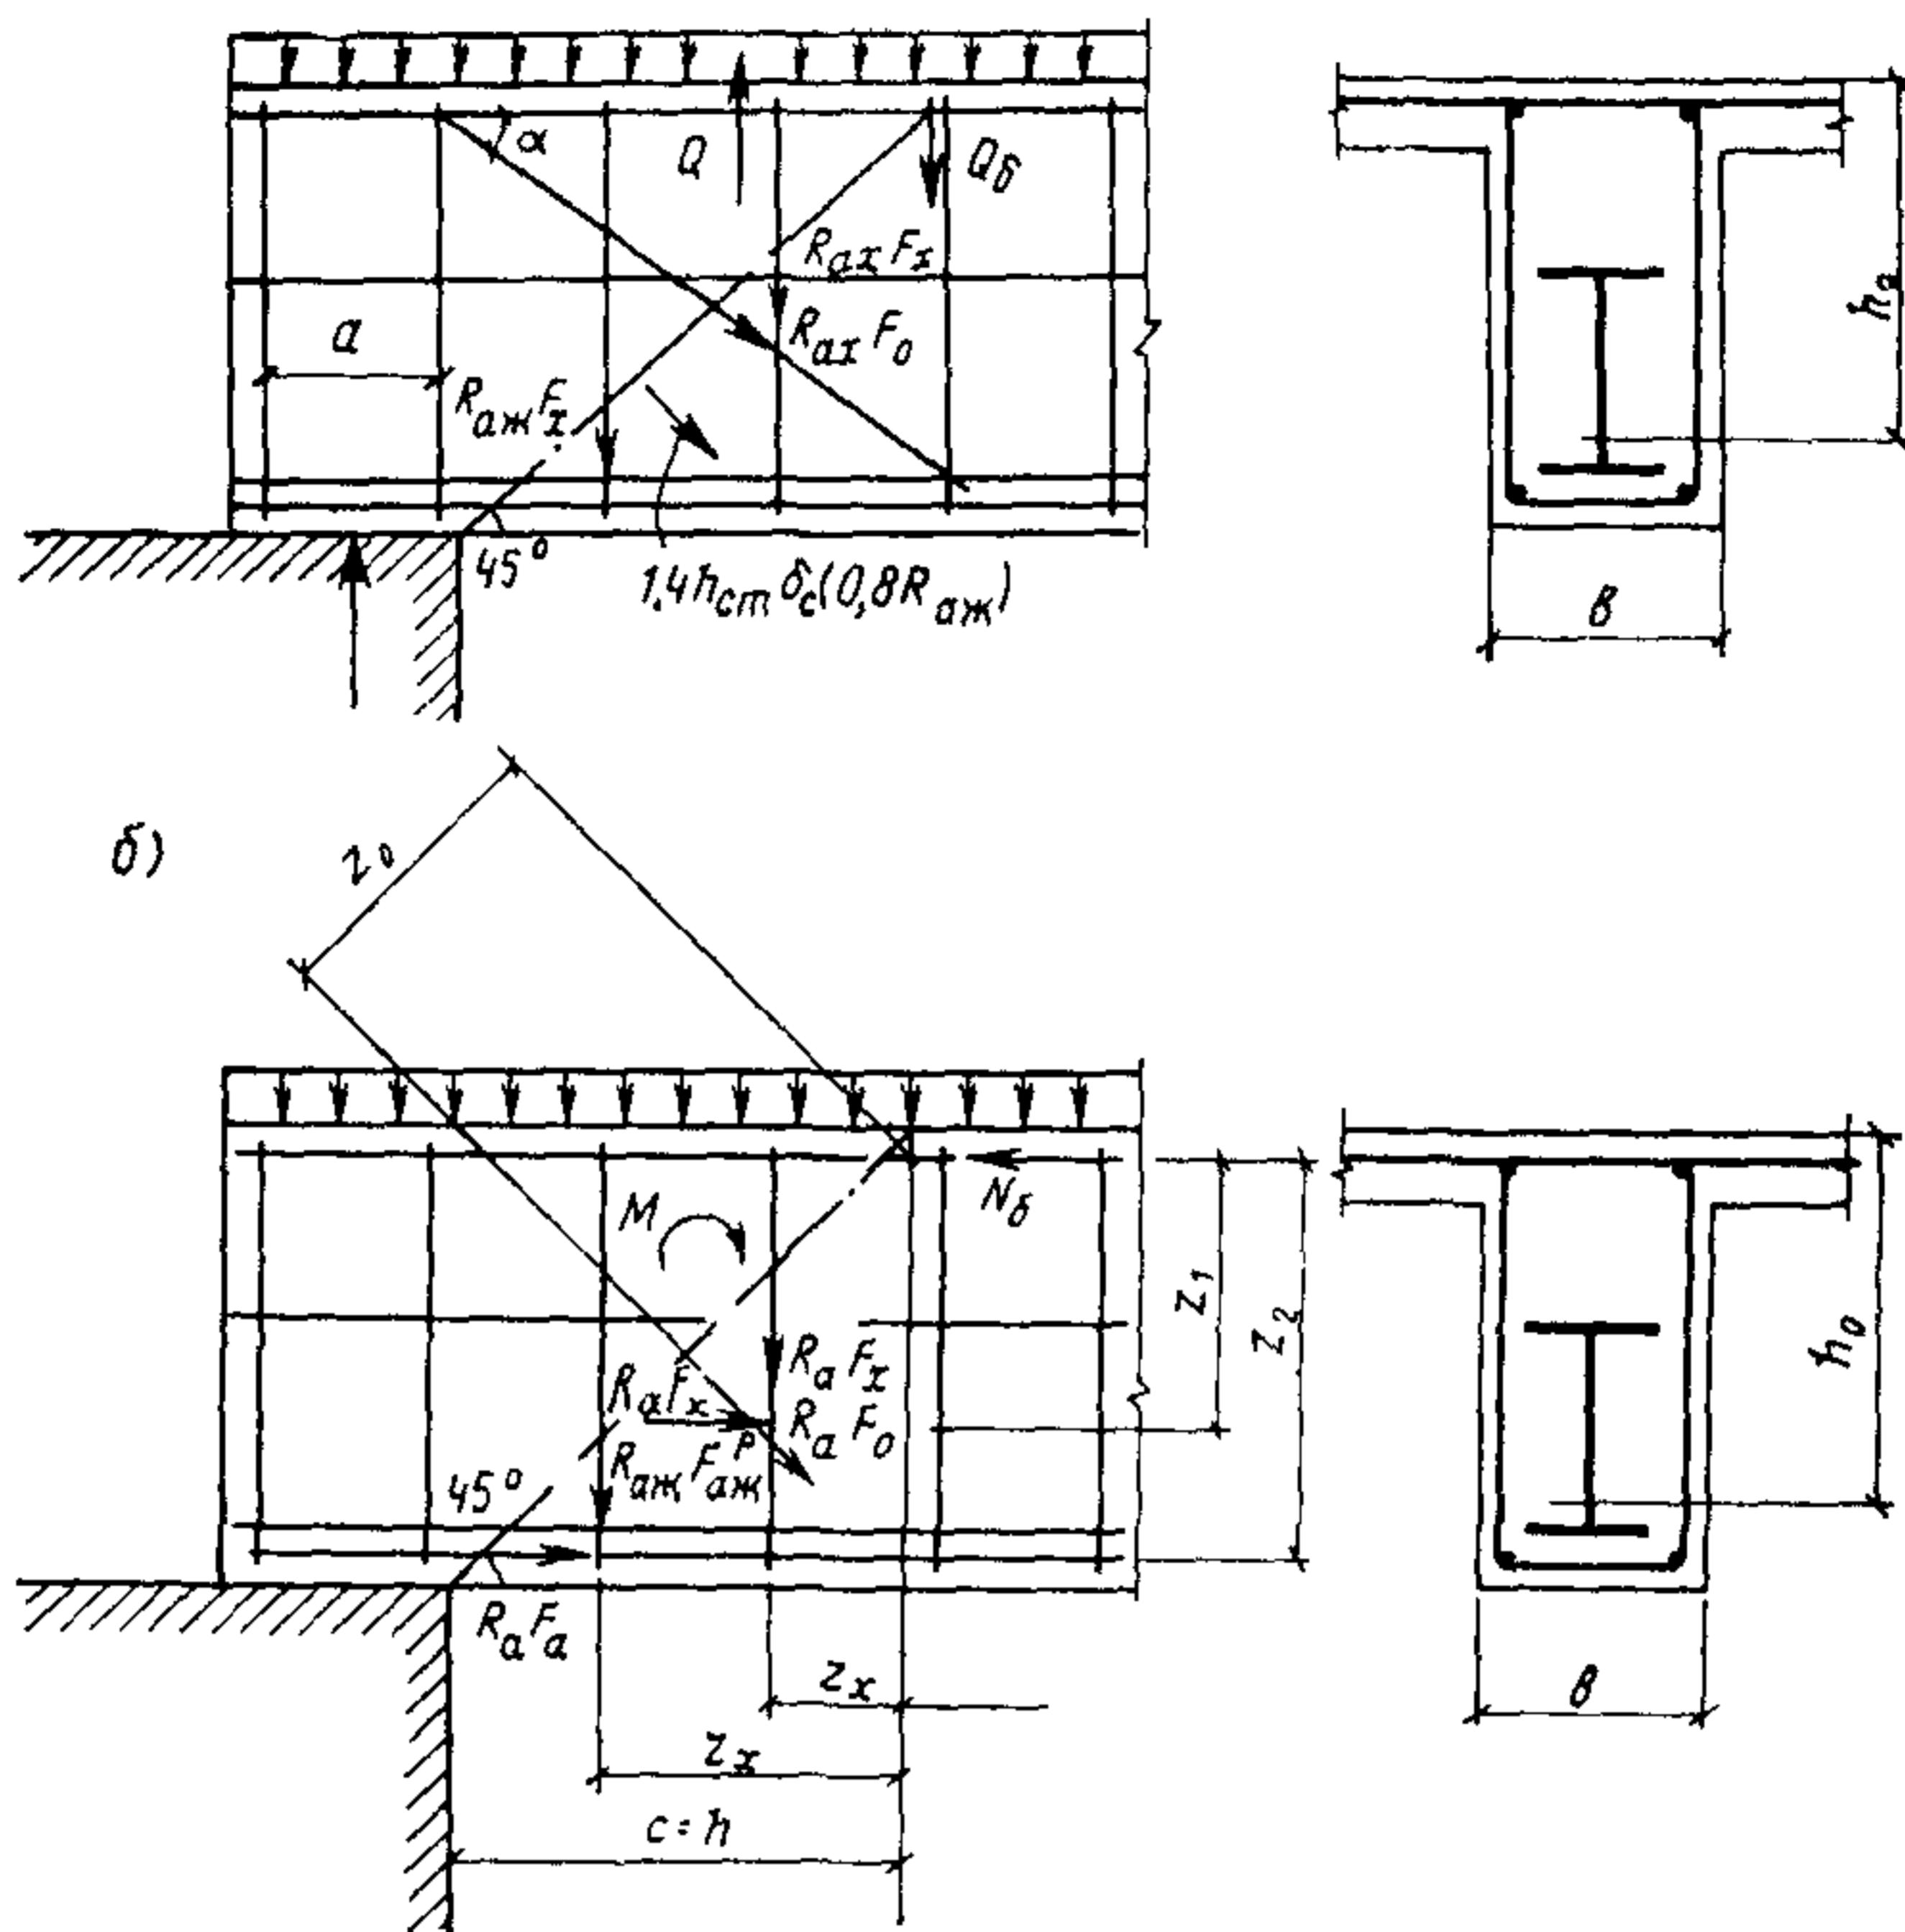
Схемы усилий при расчете наклонного сечения по прочности
